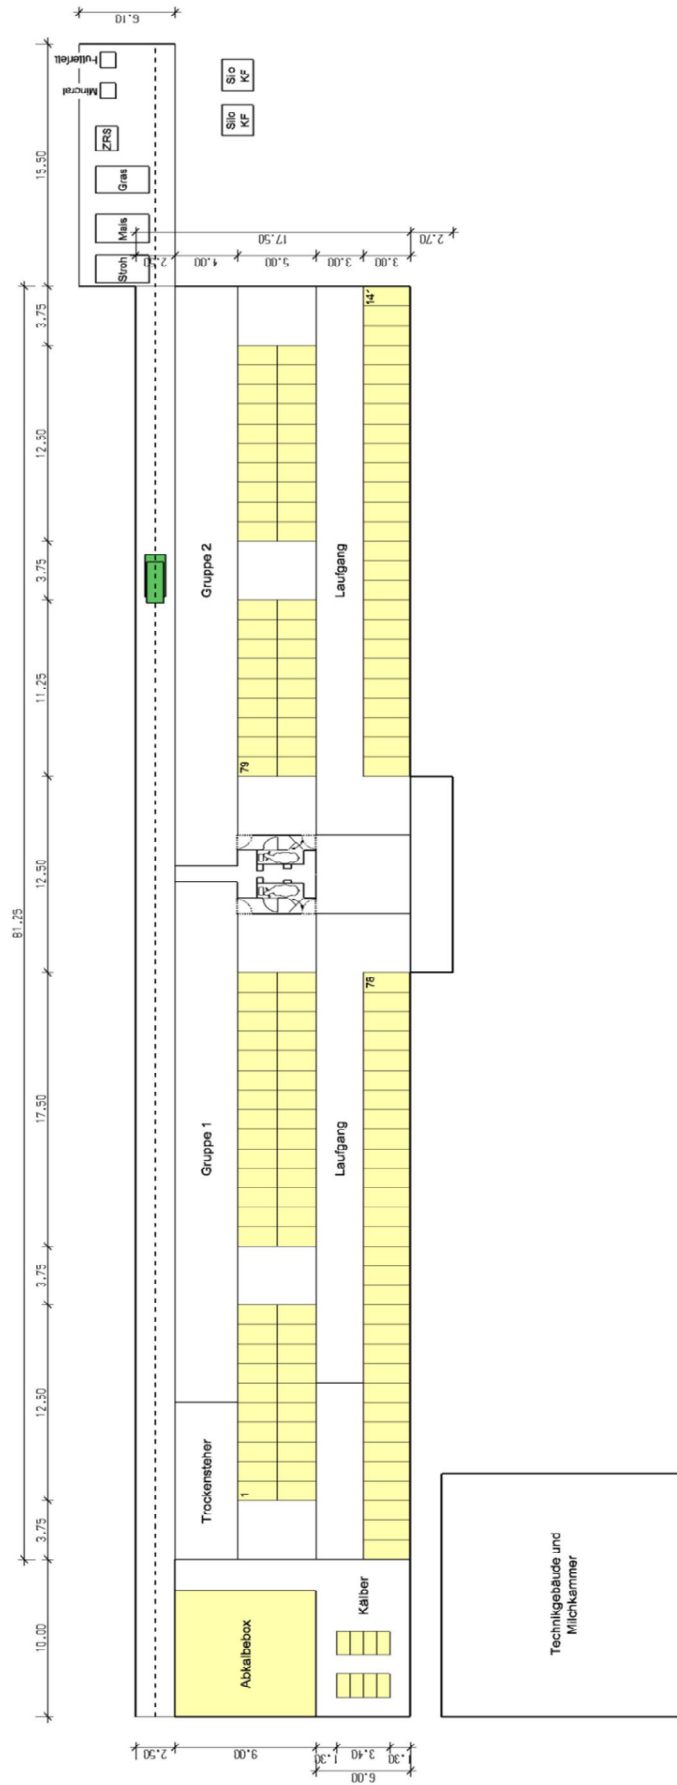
Stallgrundriss Betrieb 4 (ZRS: Zuckerrübenschnitzel, siliert, KF: Krafffutter)
